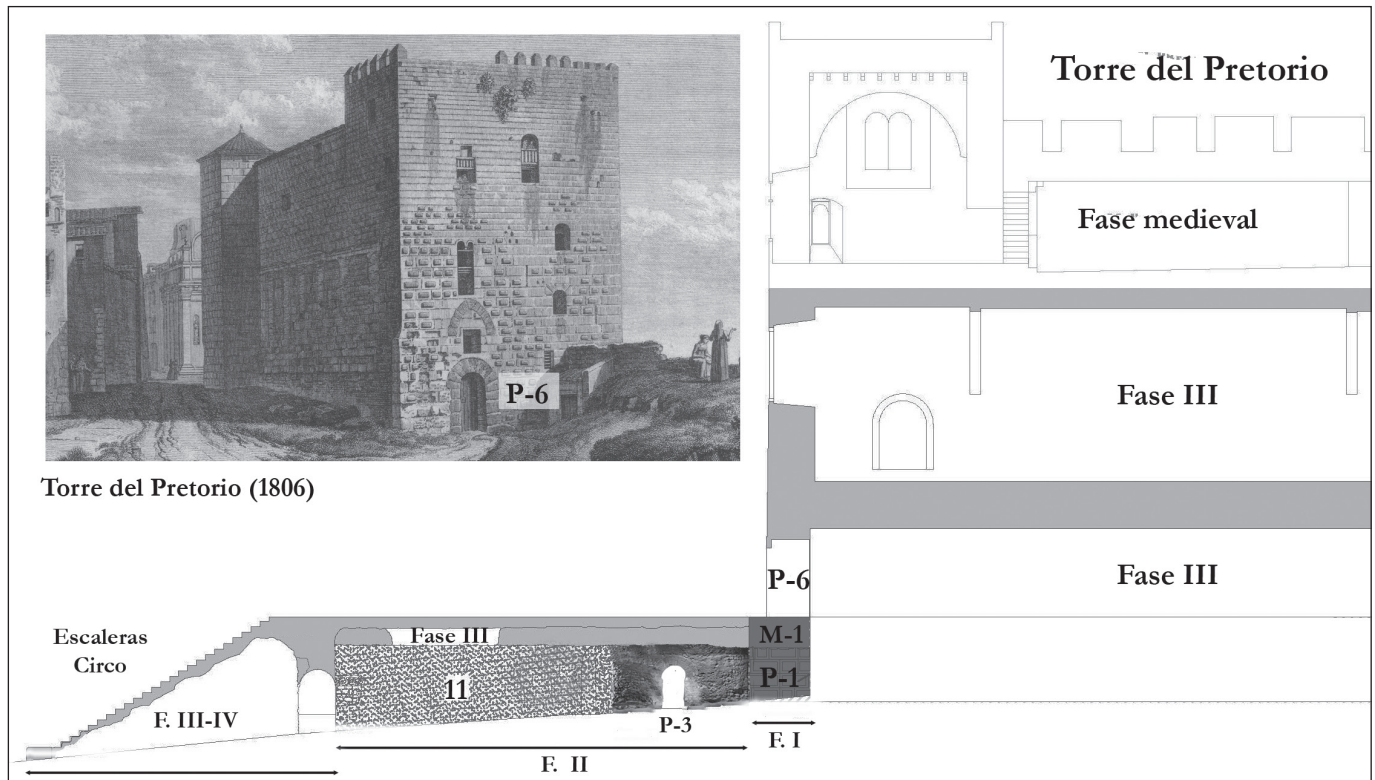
Sección longitudinal del recinto y gravado de A. de Laborde de la cara interna de la torre, decorada con pilastras (1806)
